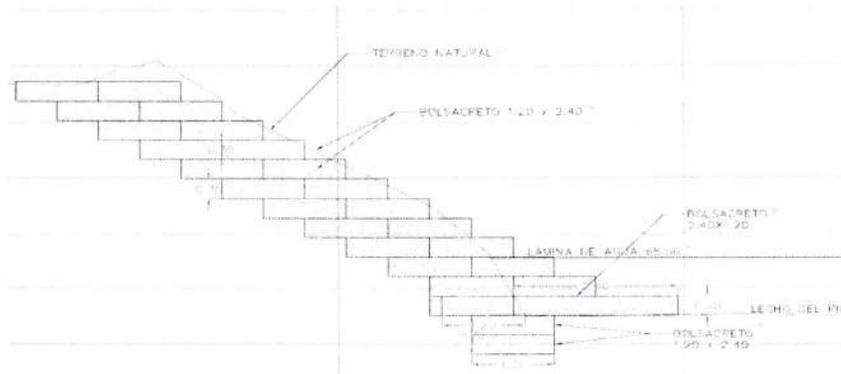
Corte transversal protección orilla aguas arriba estribo derecho
